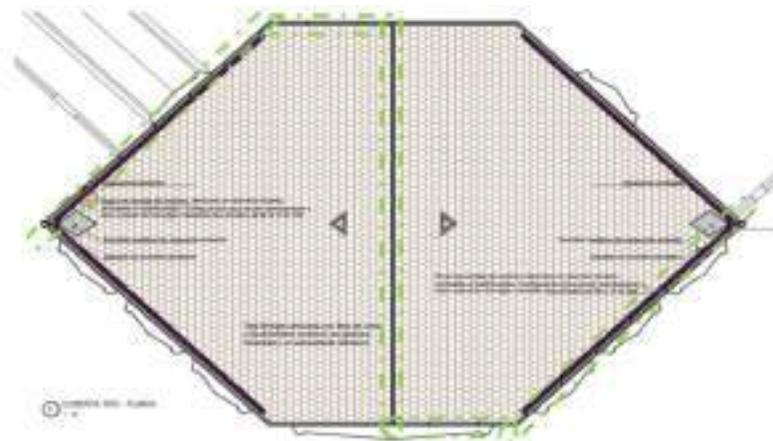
Planta de cubierta - Localización y recorrido de puntos de anclaje
